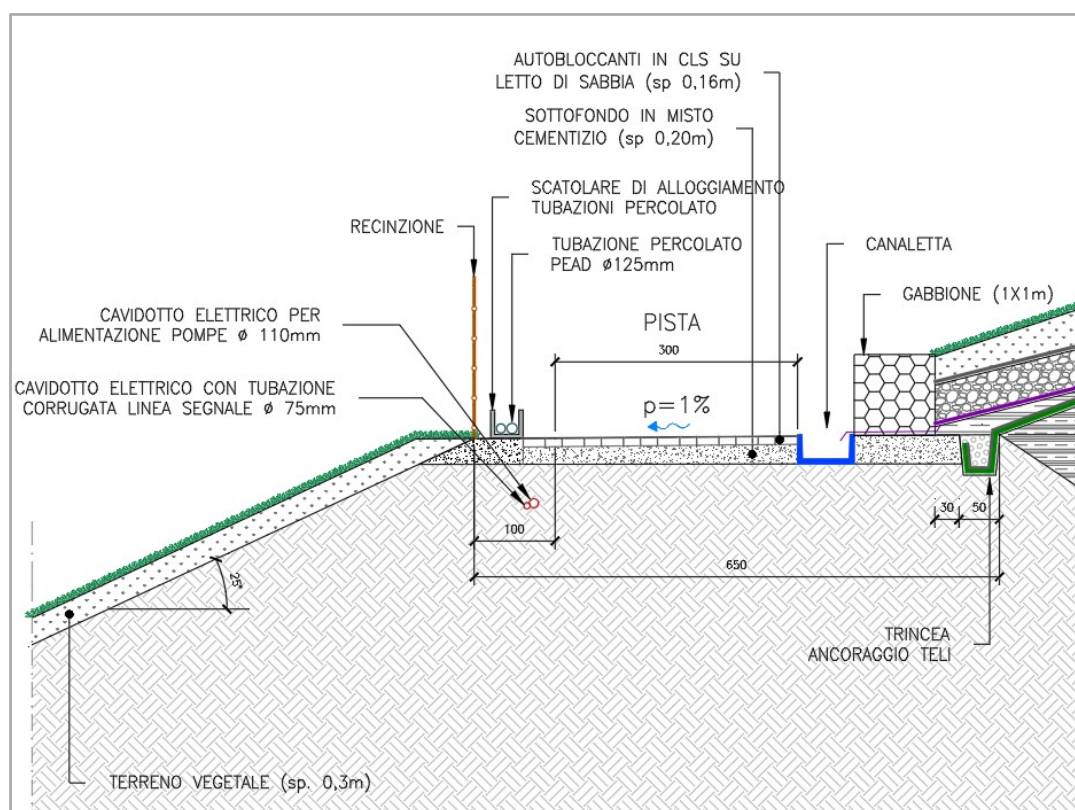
Particolare costruttivo delle sponde e delle strade interne di cantiere
